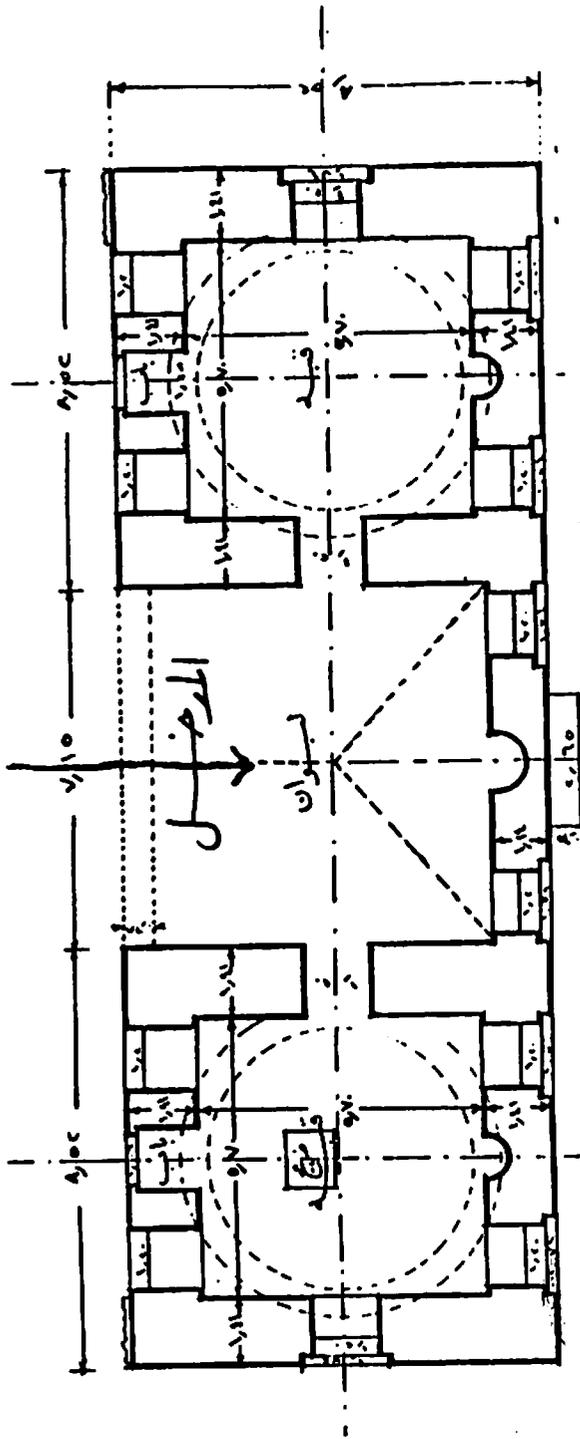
مسقط أفقي للدرسة وقبة الجاهل اليوسفي عن محاضر لجنة حفظ الآثار العربية
